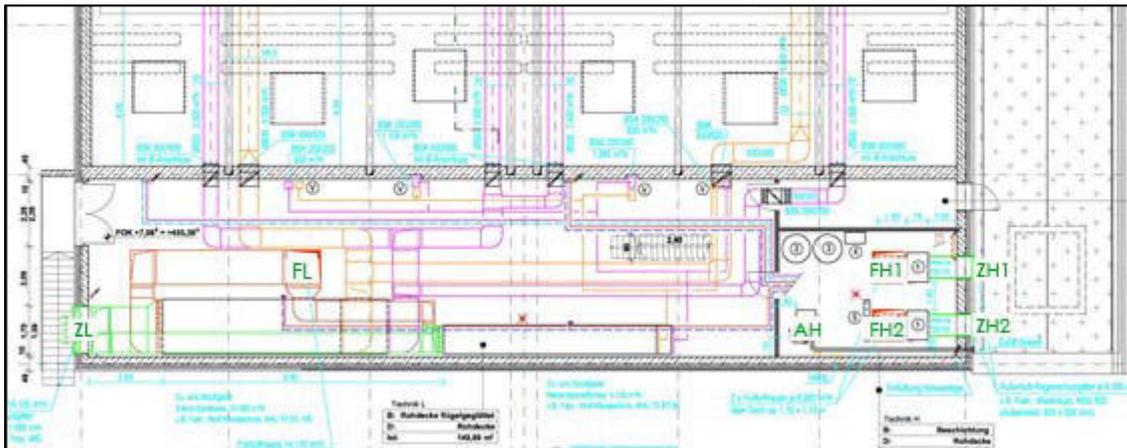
Entwurfsplan HLS Grundriss Technikgeschoss mit Eintragung der stat. Anlagen
